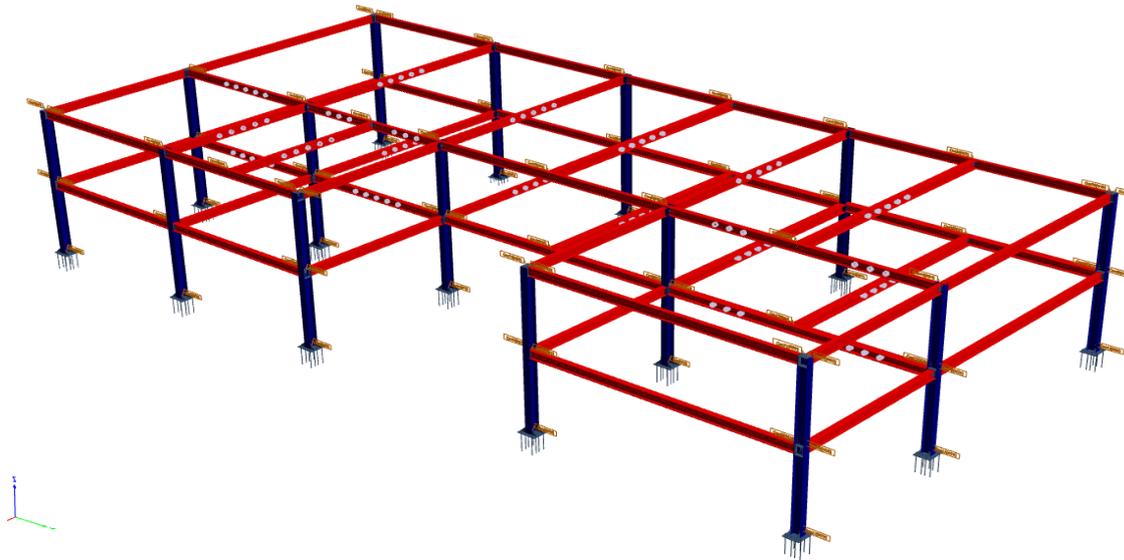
Estrutura de Aço – Estrutura com ligações finalizadas
